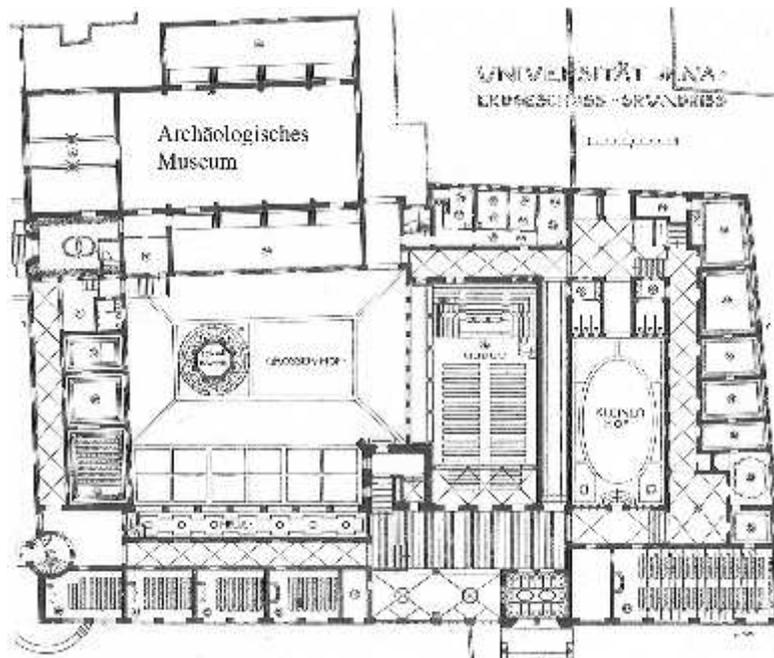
Jena, UHG, Erdgeschoß, Grundriss mit dem Archäologischen Museum (1908) (Plan ist gesüdet)
